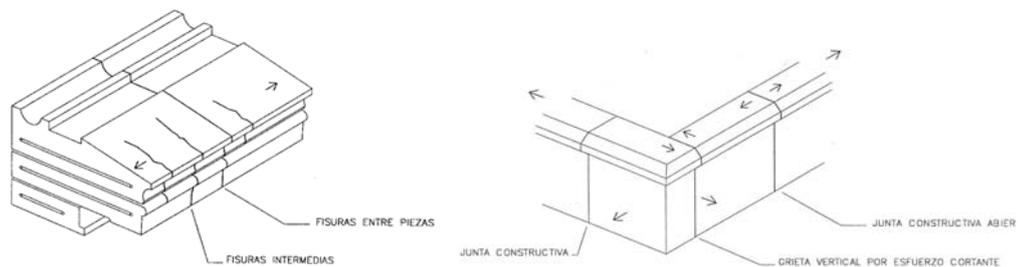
Fisuras transversales por contracción y oxidación de armaduras.
